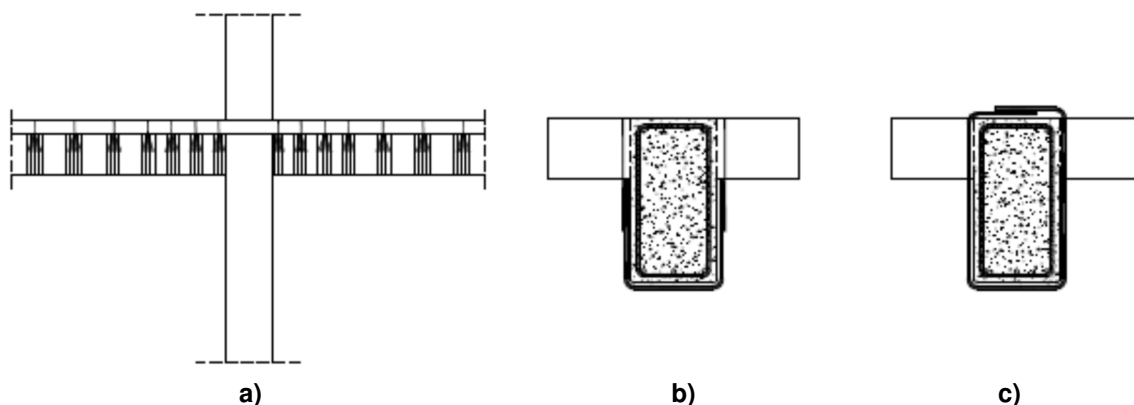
Reforzamiento a cortante discontinuo de una viga de hormigón armado interna con materiales compuestos CFRP o SRP, con dos tipologías de anclaje: a) Vista longitudinal; b) conectores en abanico; c) Franjas pasantes con traslape de al menos 20 cm en la parte superior de las vigas.
